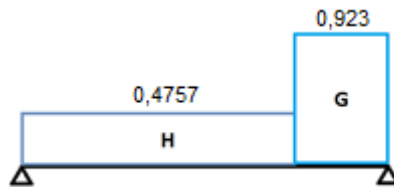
Viga 8B-7B, 8C-7C y 8D-7D
